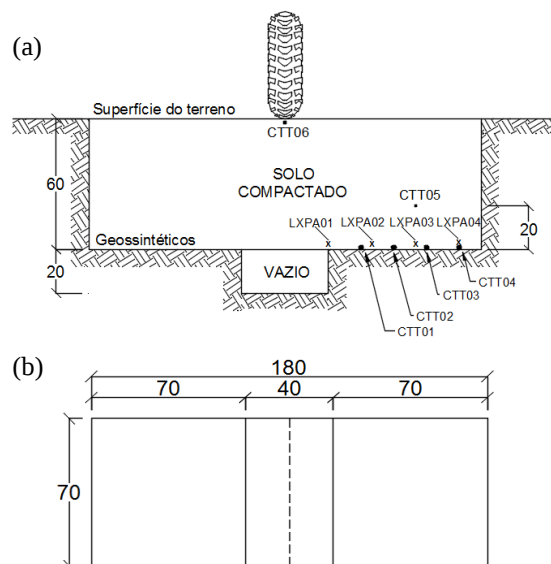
Geometria da vala escavada: (a) em corte; (b) em planta. Medidas em centímetros.
